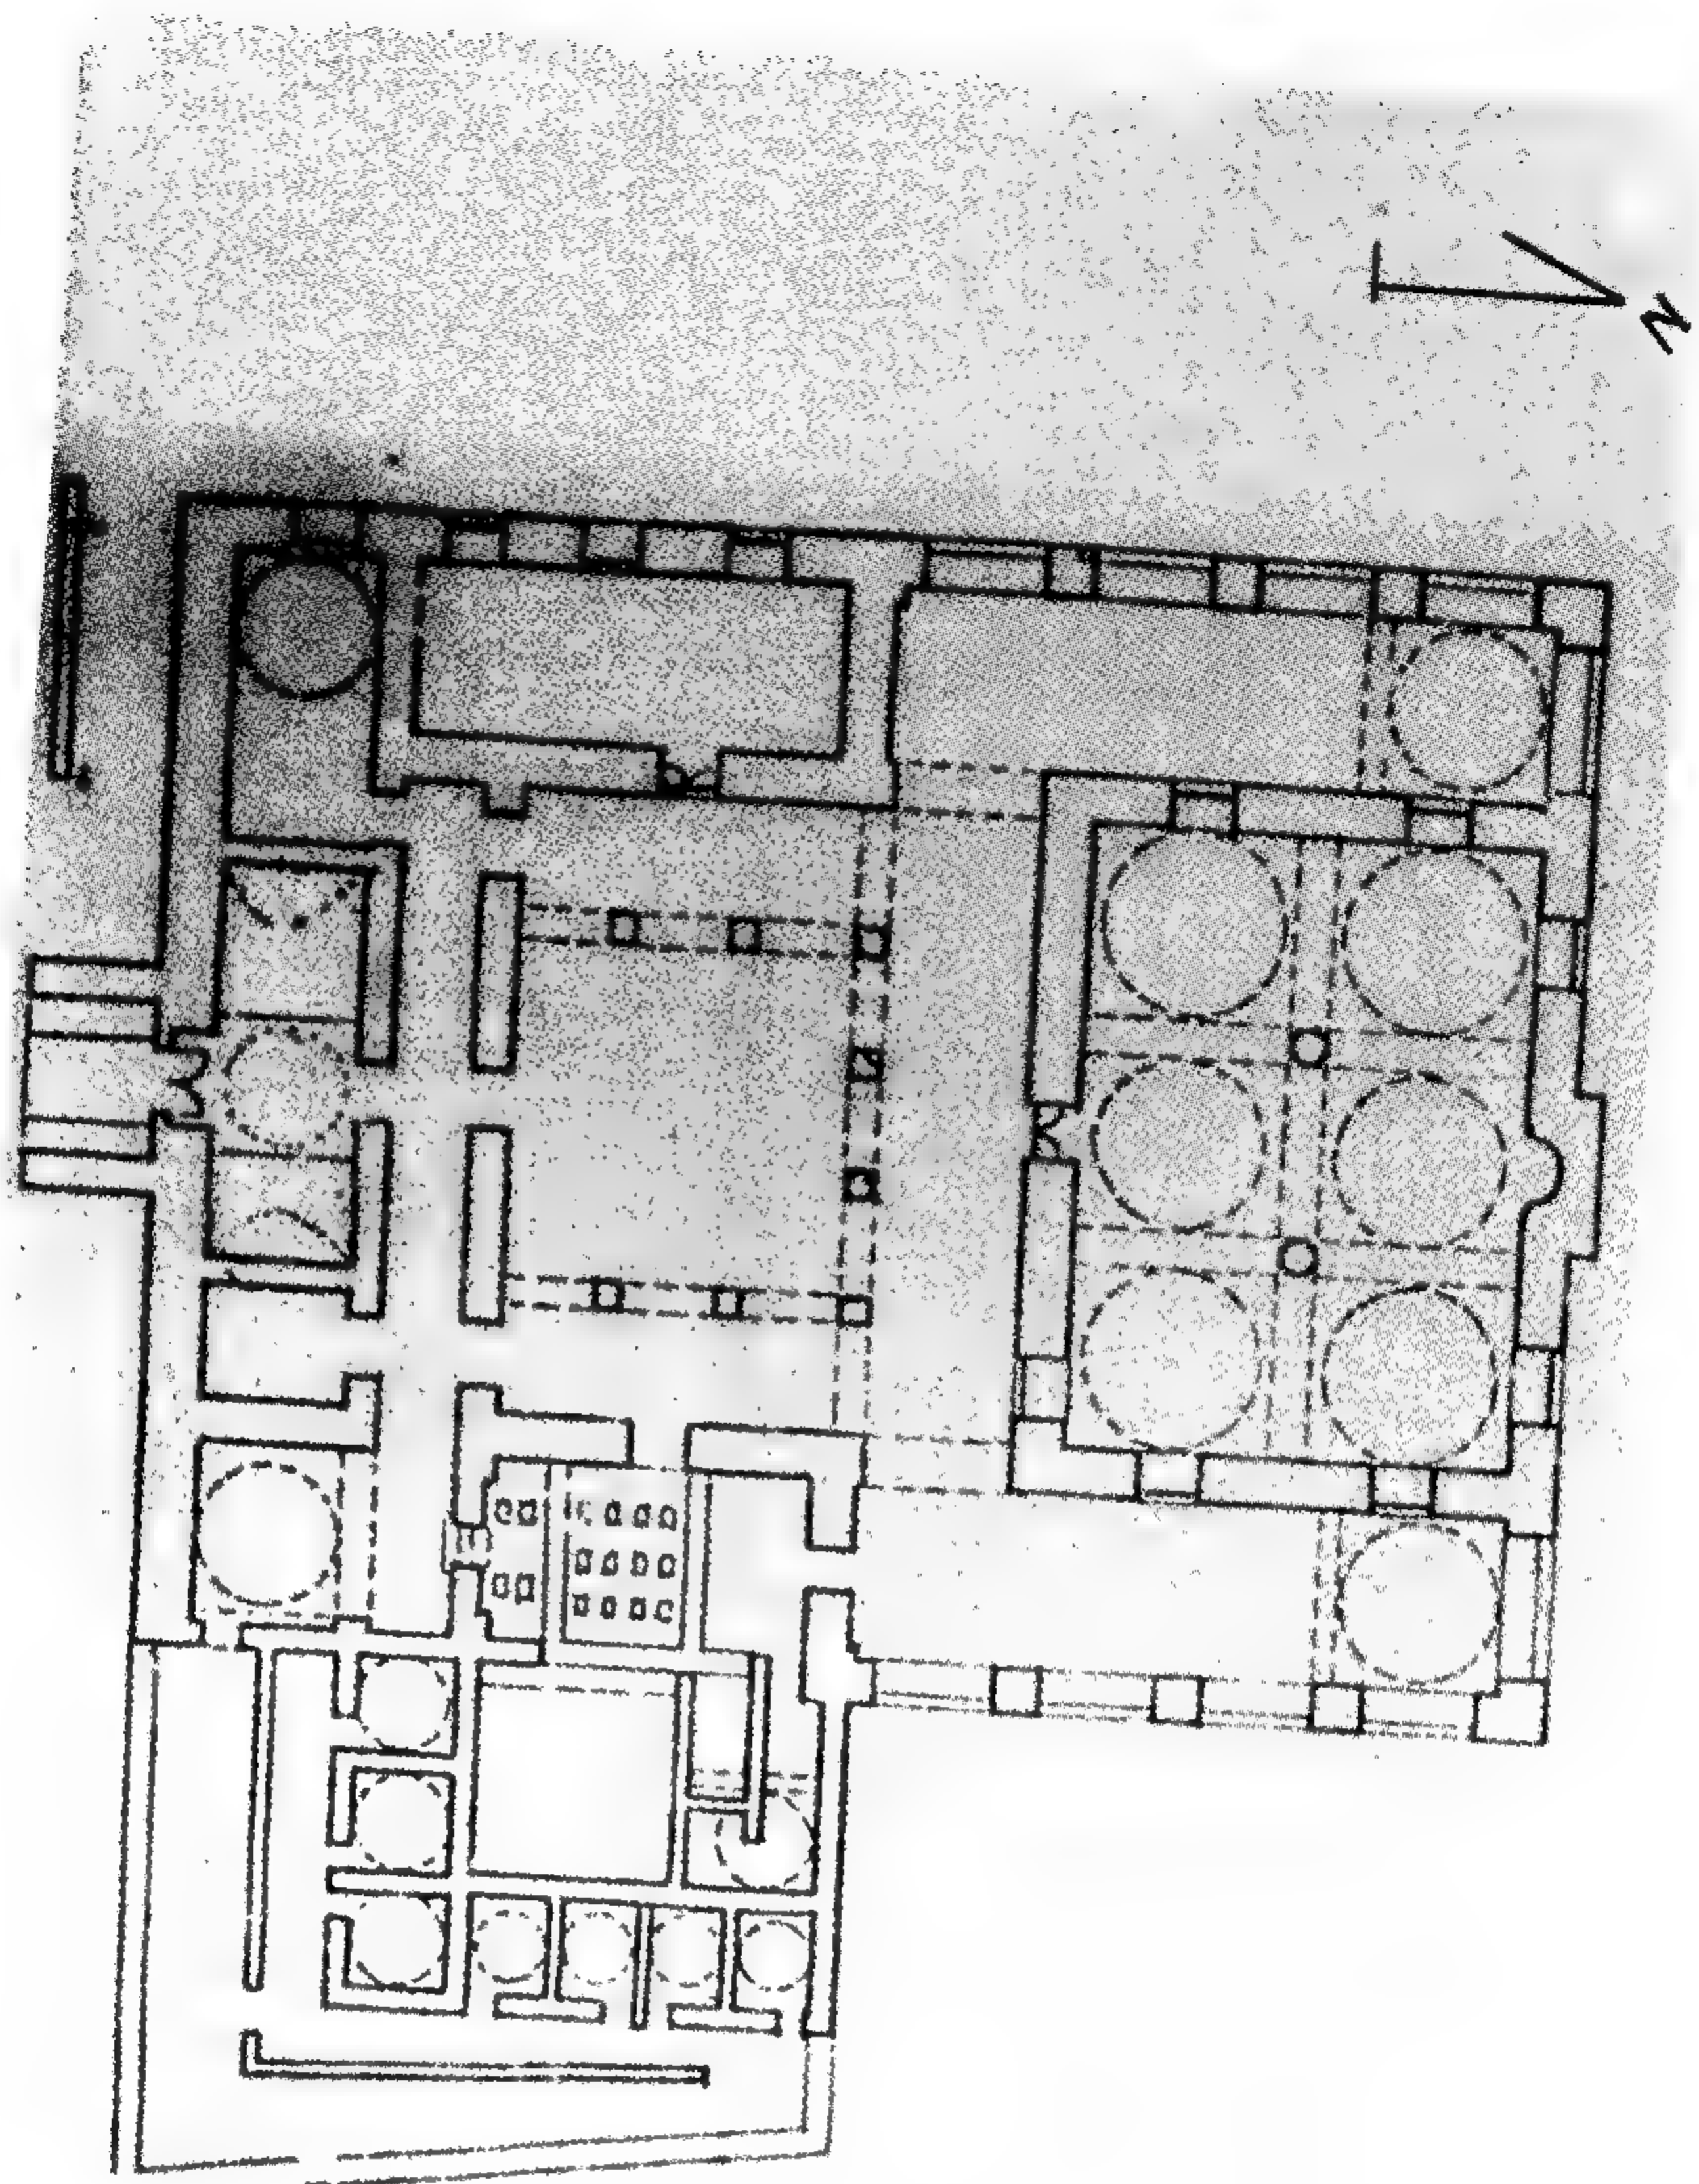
مسقط أفقى مبدئى للجامع الكبير بثلا .
